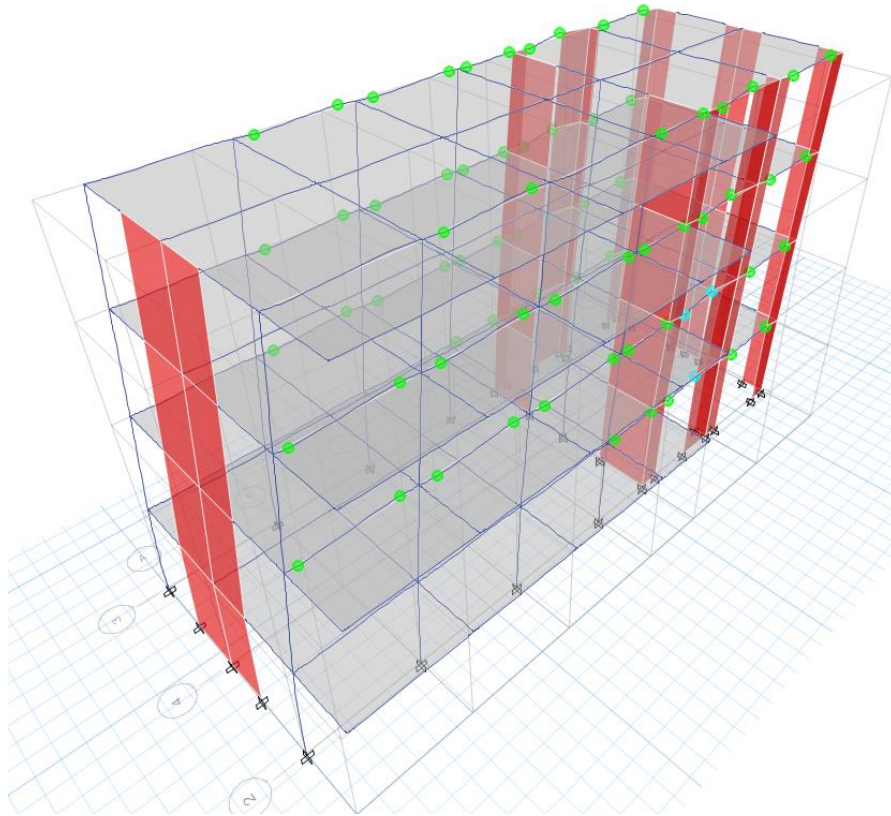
Generación de rotulas plásticas en X. Fuente: Elaboración propia.
